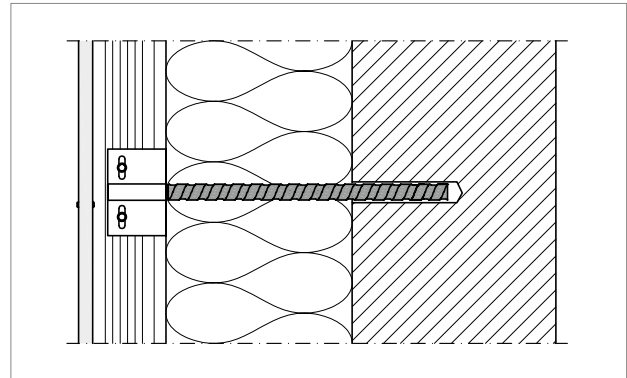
Schöck Isolink® Typ F: Verankerung im Mauerwerk
